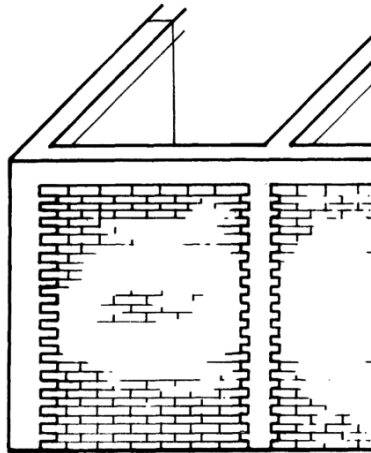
Estructura de hormigón armado con relleno de mampostería. Adaptado de Minke (2005)
